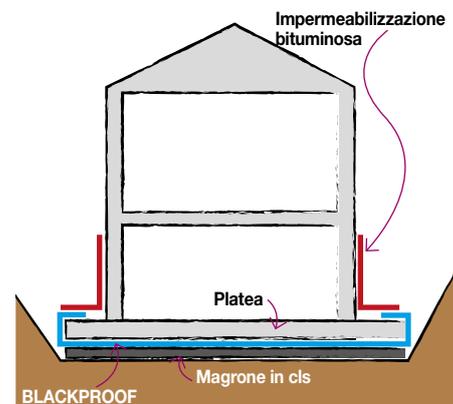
Impermeabilizzazione pre-getto della platea e raccordo all'impermeabilizzazione bituminosa delle pareti
